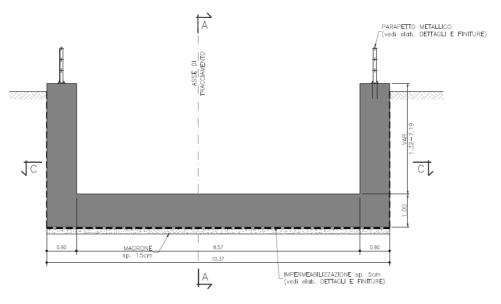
Muro d'imbocco - Sezione trasversale
